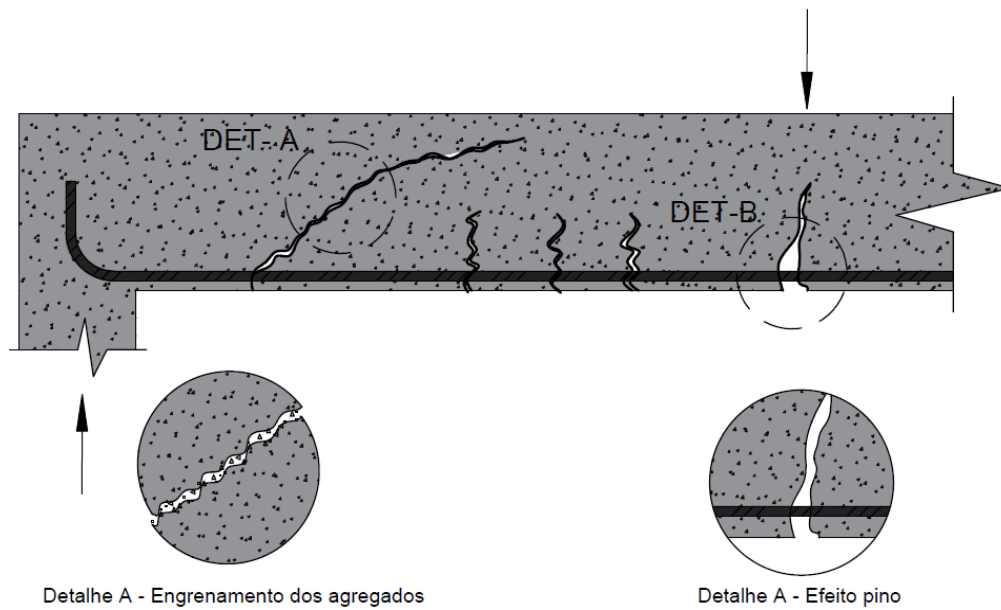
Efeito pino e engrenamento dos agregados em vigas de concreto armado fissurado
